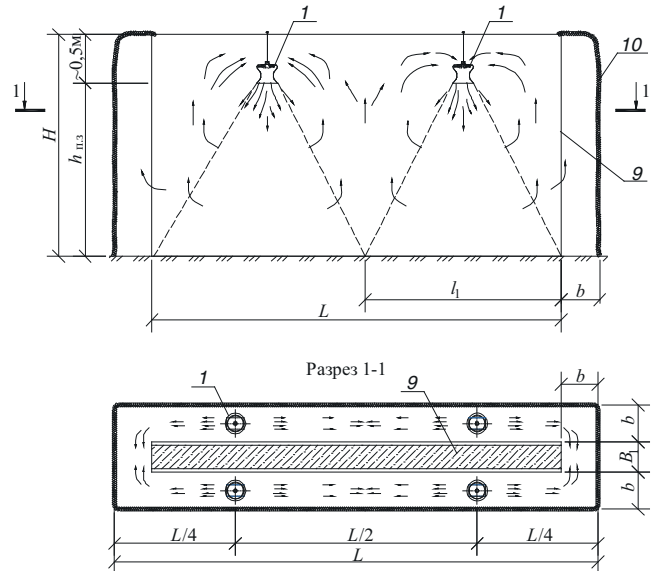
Схема размещения УВКП для прогрева монолитной железобетонной стены. Обозначения см. на рис. 2
